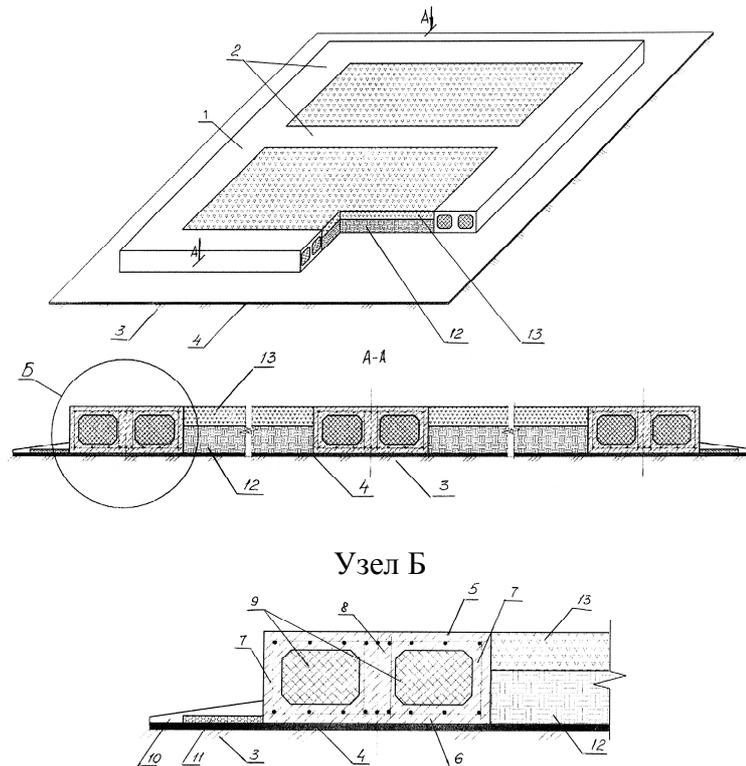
Плитно-рамный фундамент для малоэтажного строительства:
